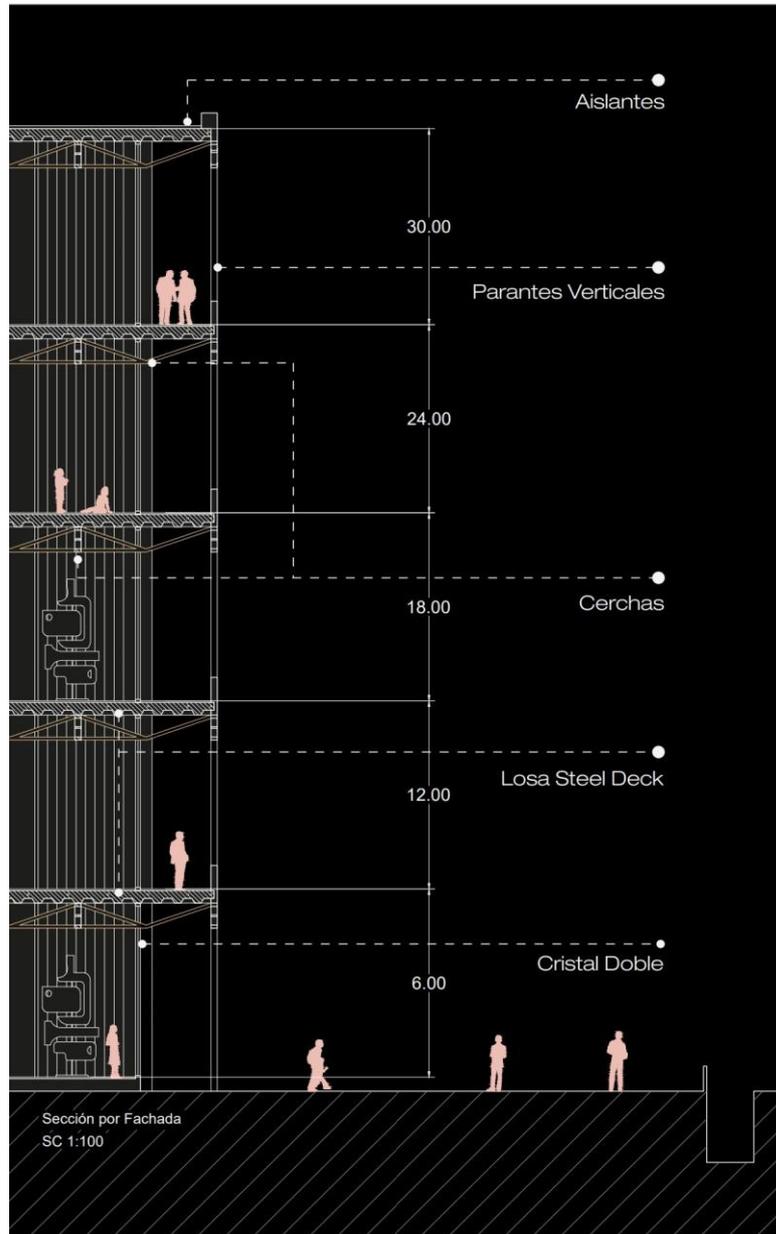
Tec. Corte por Fachada. Elaboración Propi
